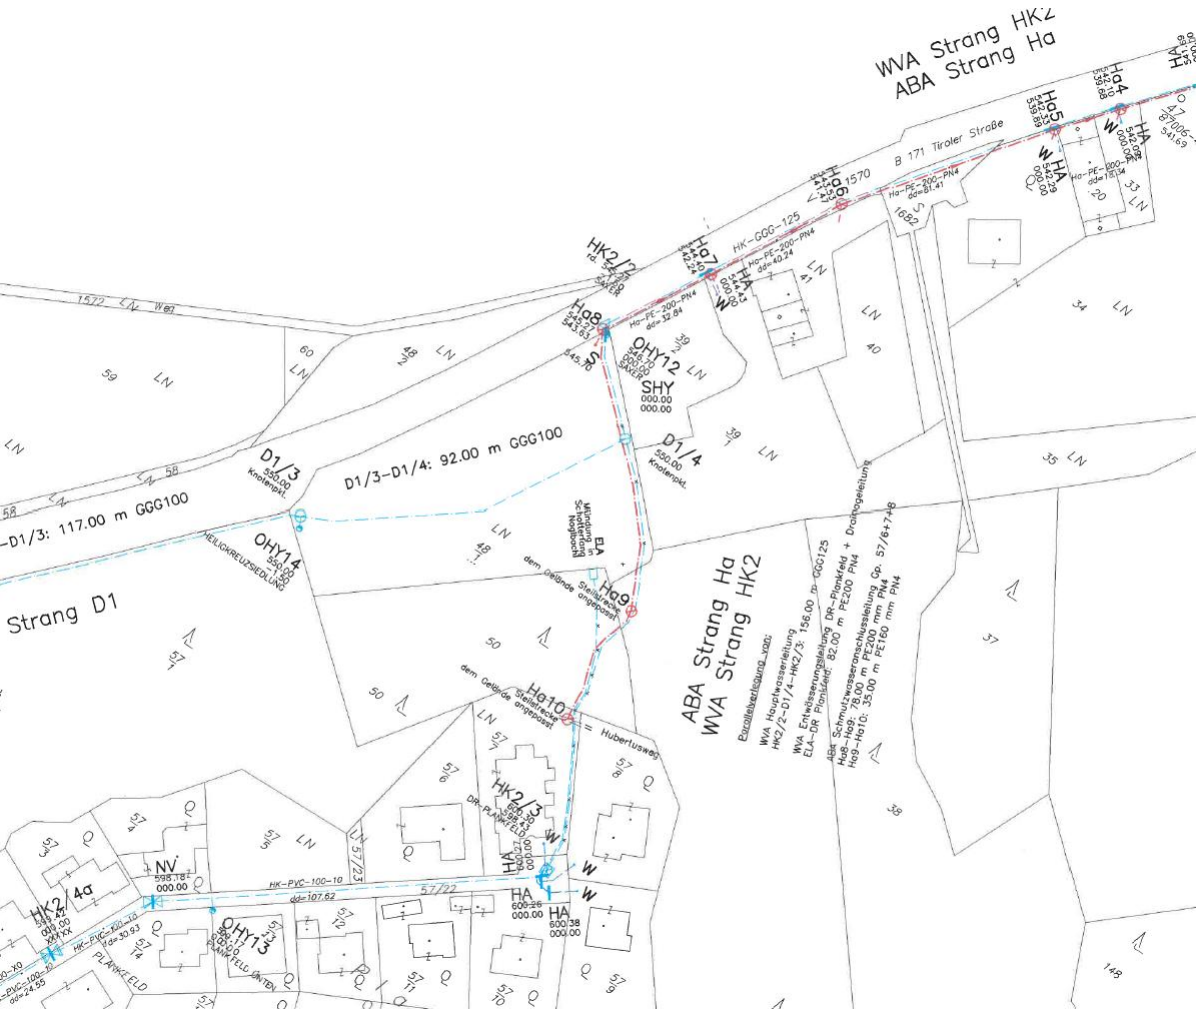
Leitungsplan Wasser (Stadtgemeinde Pill, v. 21.04.2026)
